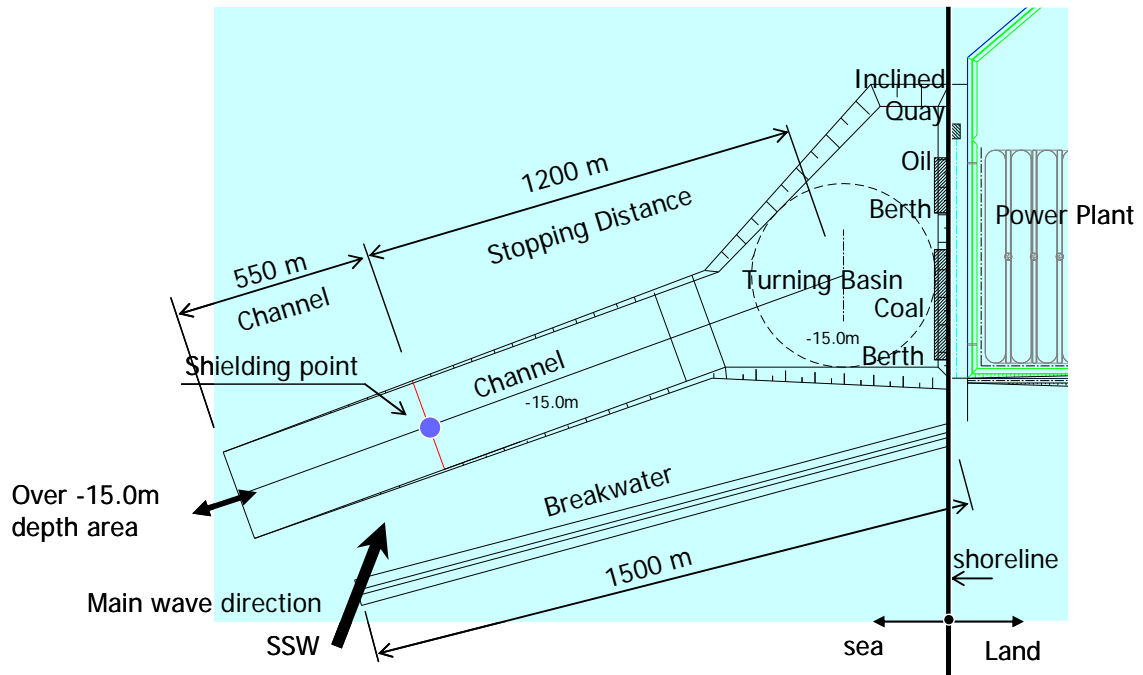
Plan A: 配置図 (Conventional Port Type)
